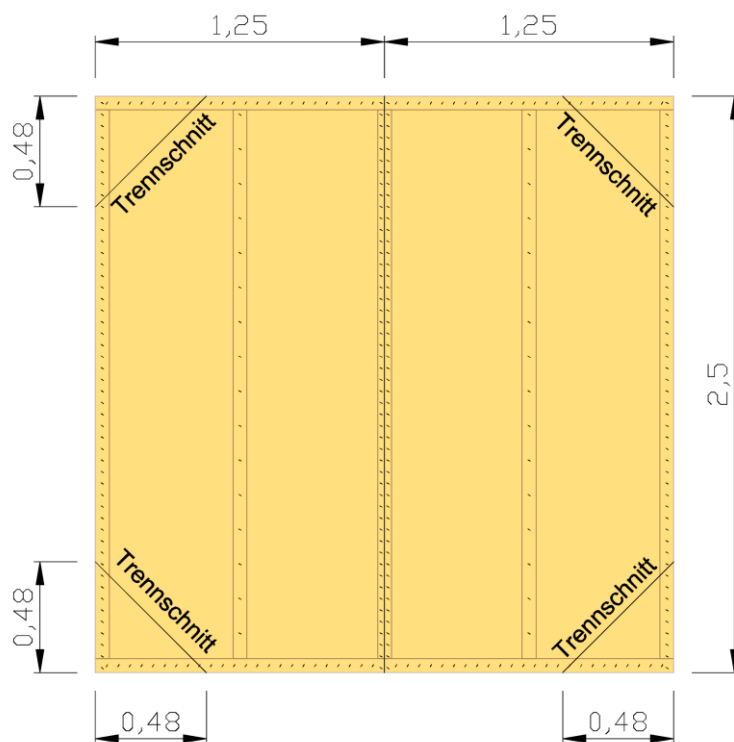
Abmessungen des Versuchs OSB-12,0 H-1-1-1-50-k. Der Winkel zwischen Klammerrücken und Faserrichtung beträgt 60°. Es wurden zwei Platten je 1,25 m x 2,50 m als Beplankung verwendet. In den Ecken der Wand wurden Trennschnitte angeordnet. Alle Maße in Meter.
